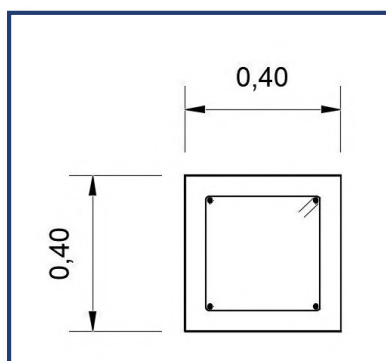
Sección propuesta de las vigas de atado de 5 metros.
